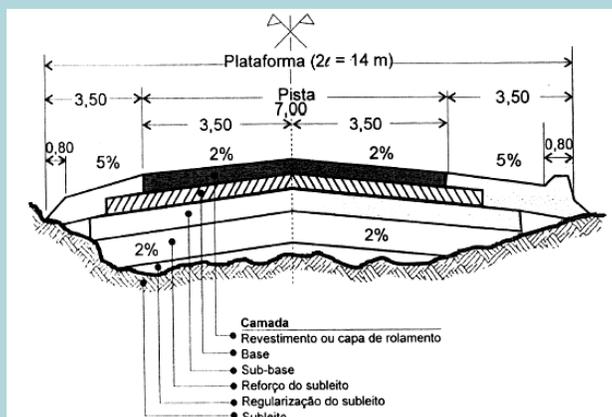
Seção Transversal de um Pavimento Flexível.
